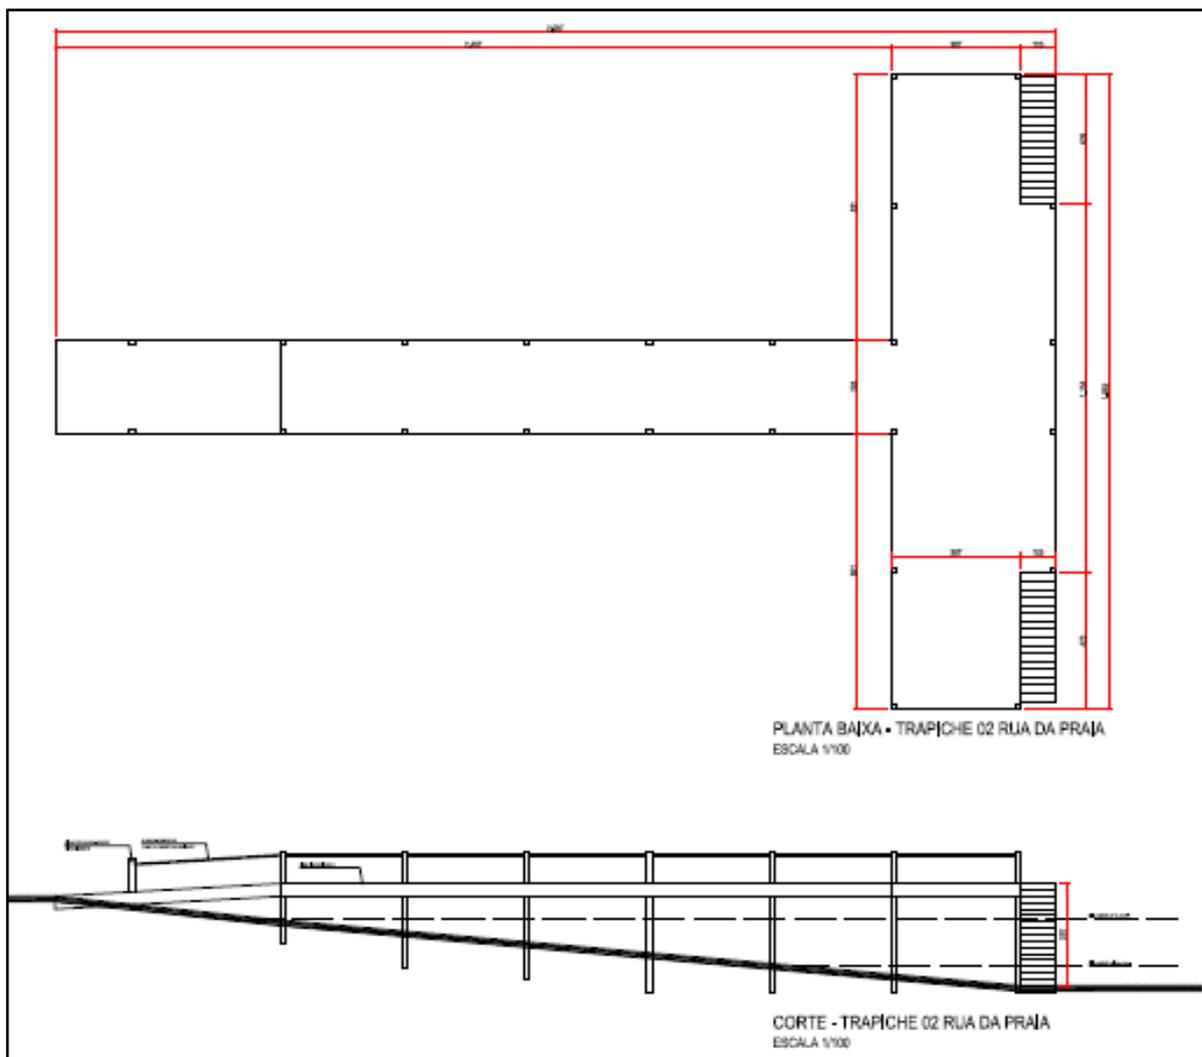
Trapiche de embarque para outras linhas regulares – Planta baixa e corte
